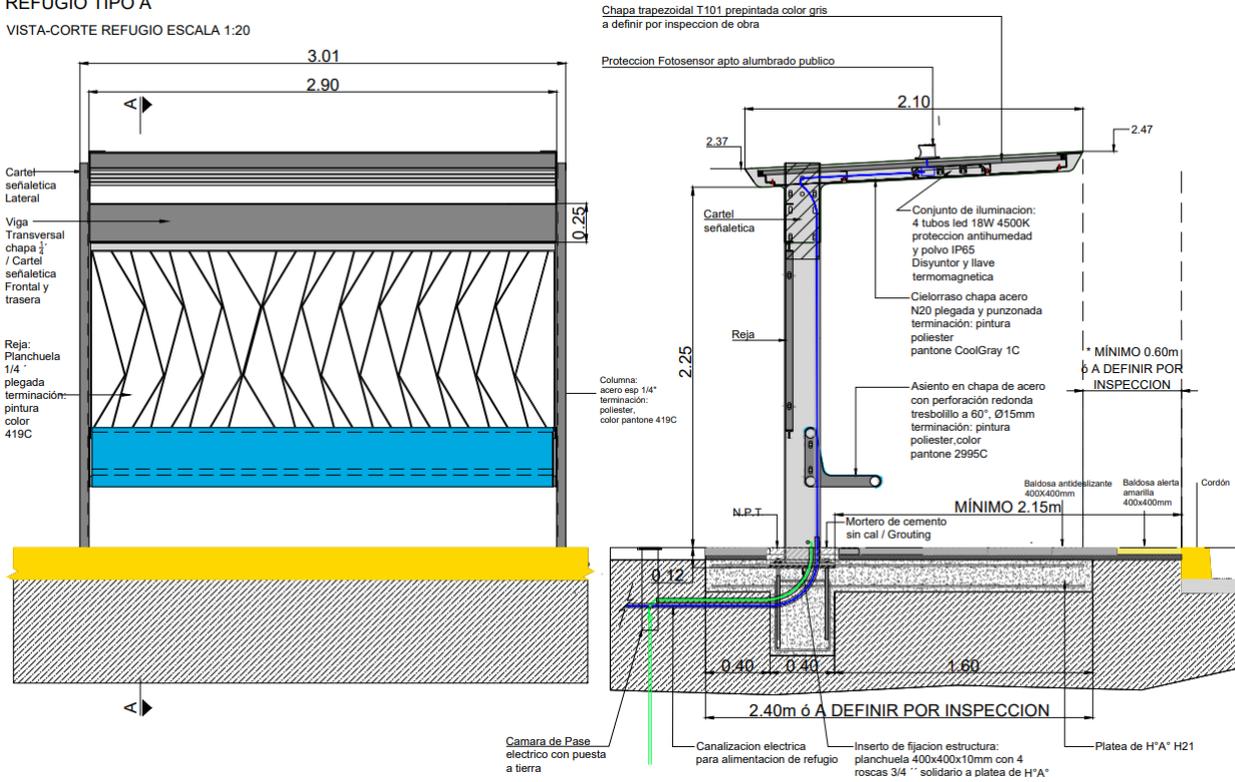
A. – Vista y Corte del Refugio Tipo A utilizado por el Ministerio de Obras Públicas de la Nación
